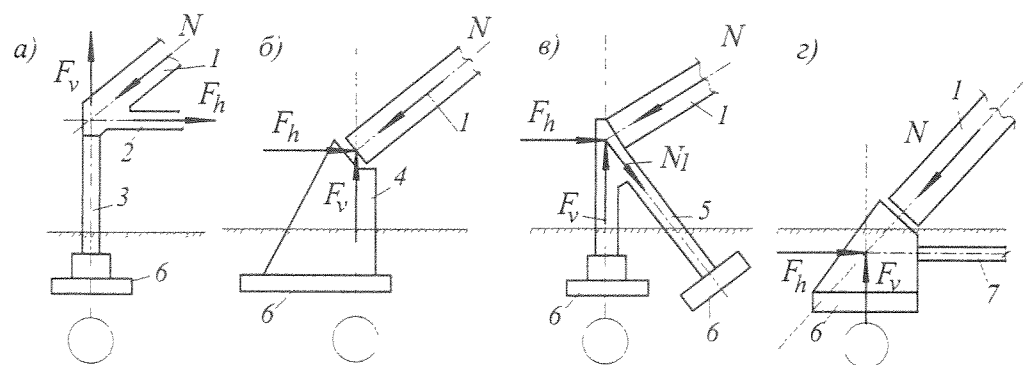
Варианты опирания железобетонных арок и способы погашения распора:
